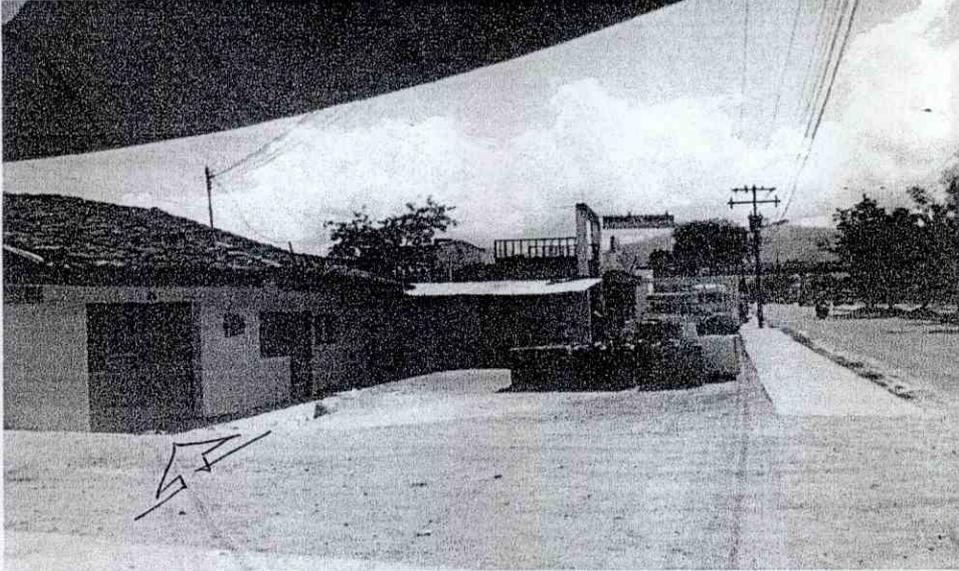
VISTA FACHADA SOBRE LA CALLE 21 SUR
